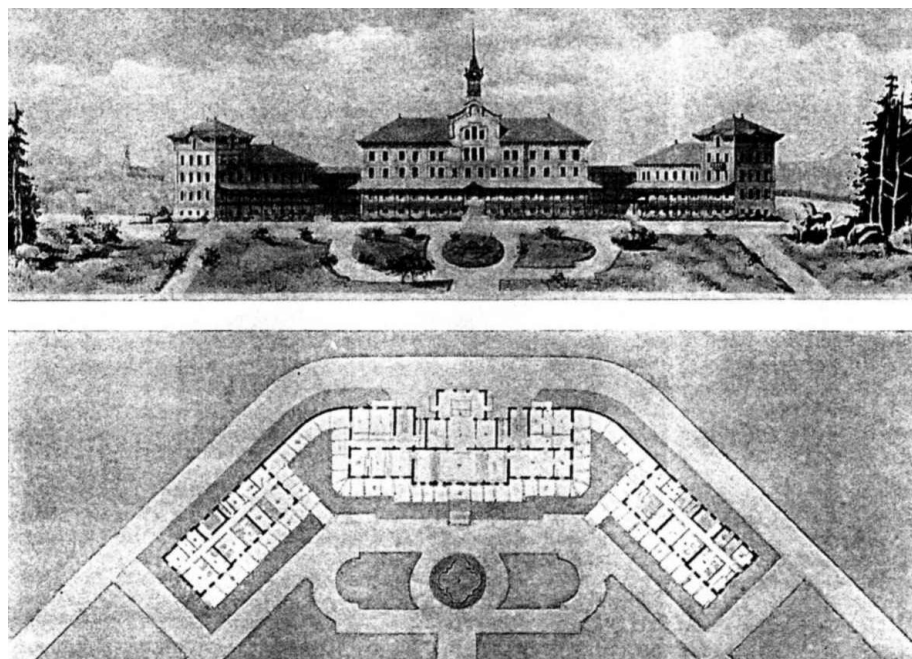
Sanatorio di Hauteville, pianta e prospetto (da F. DONATI, *op. cit.*, p. 18)
